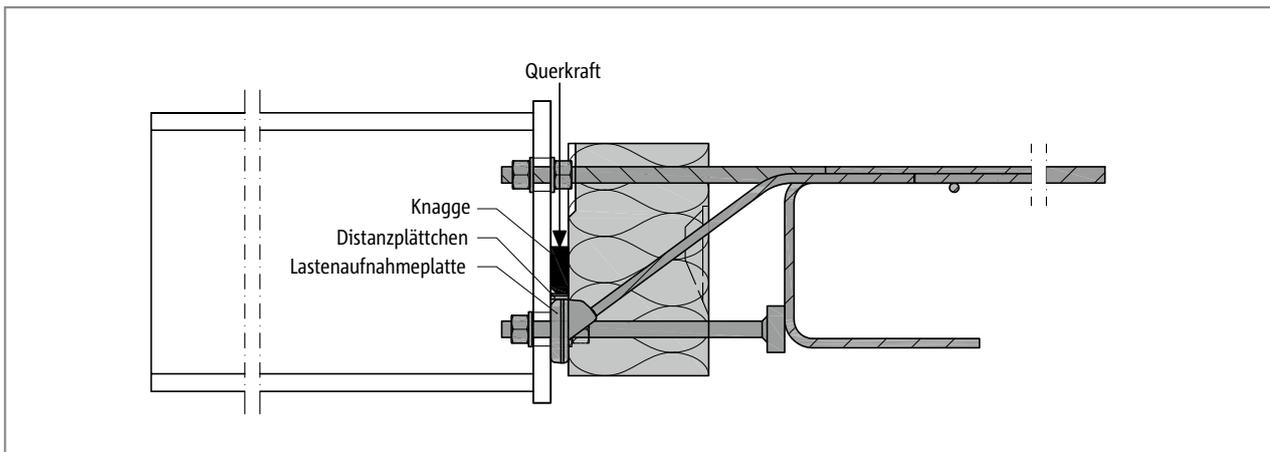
Schöck Isokorb® XT Typ SK: Bauseitige Knagge zur Übertragung der Querkraft
